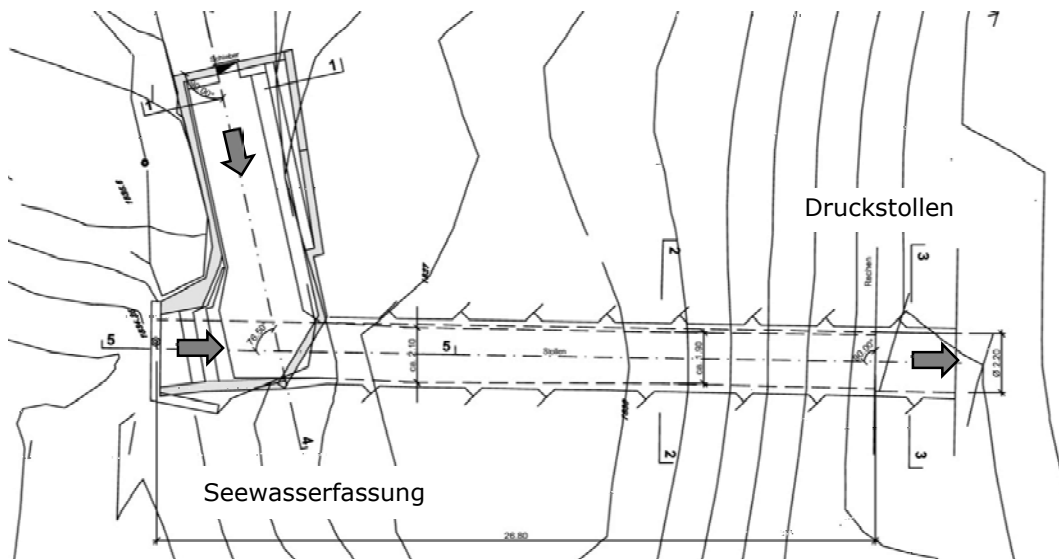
Grundriss der Seewasserfassung (Ausschnitt Plan Nr. 2000).
